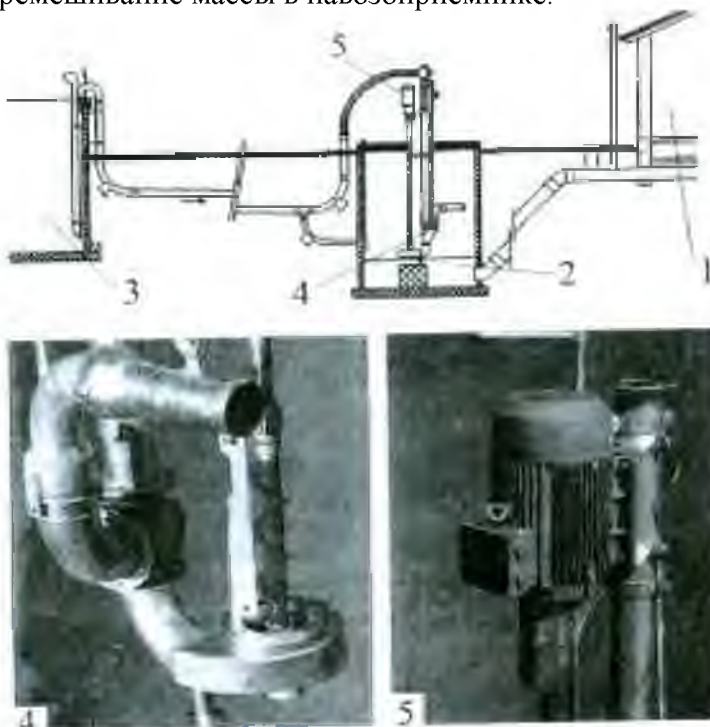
Подача бесподстилочного навоза в хранилище: 1 – животноводческое помещение; 2 – навозоприемник; 3 – навозохранилище; 4 – насос фирмы Kimadan; 5 – привод насоса
